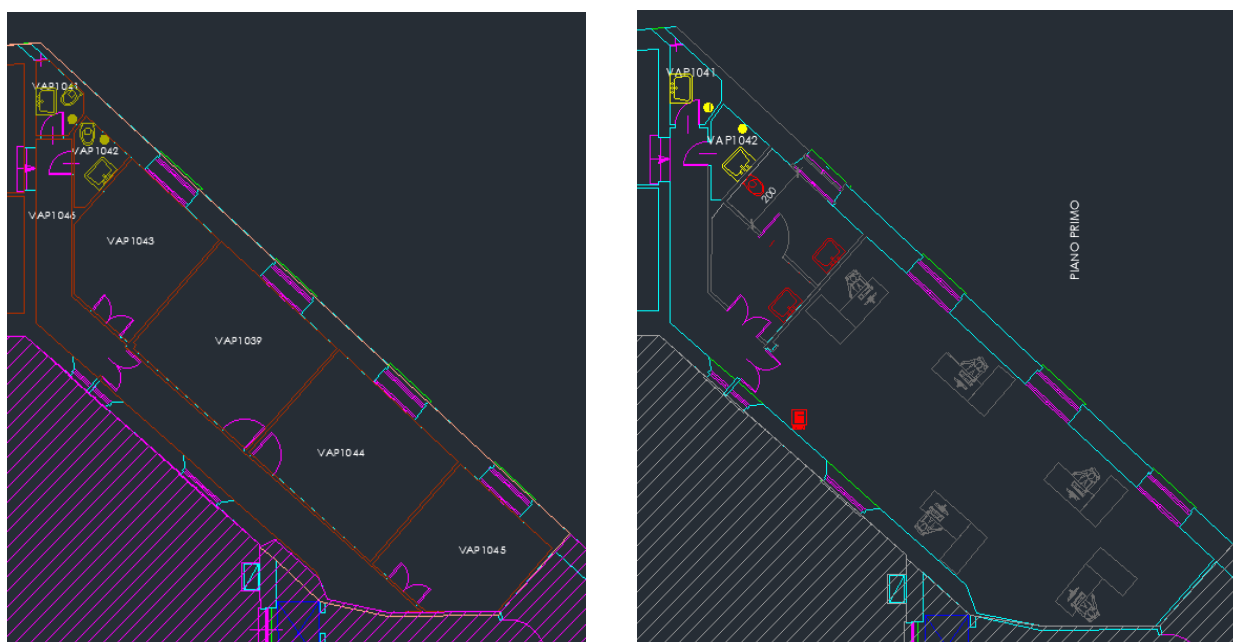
Locali di via Grenchen sede degli interventi del progetto: a sinistra lo stato attuale, a destra lo stato del progetto.
